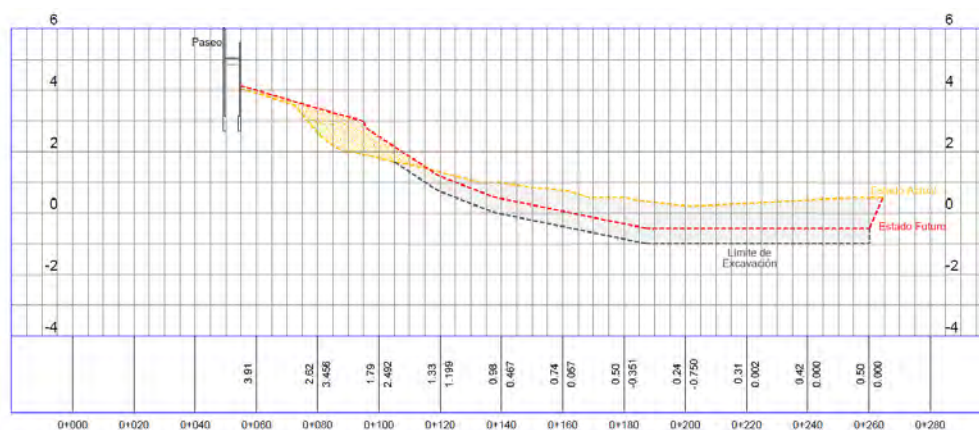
Perfil longitudinal. Fuente: elaboración propia
